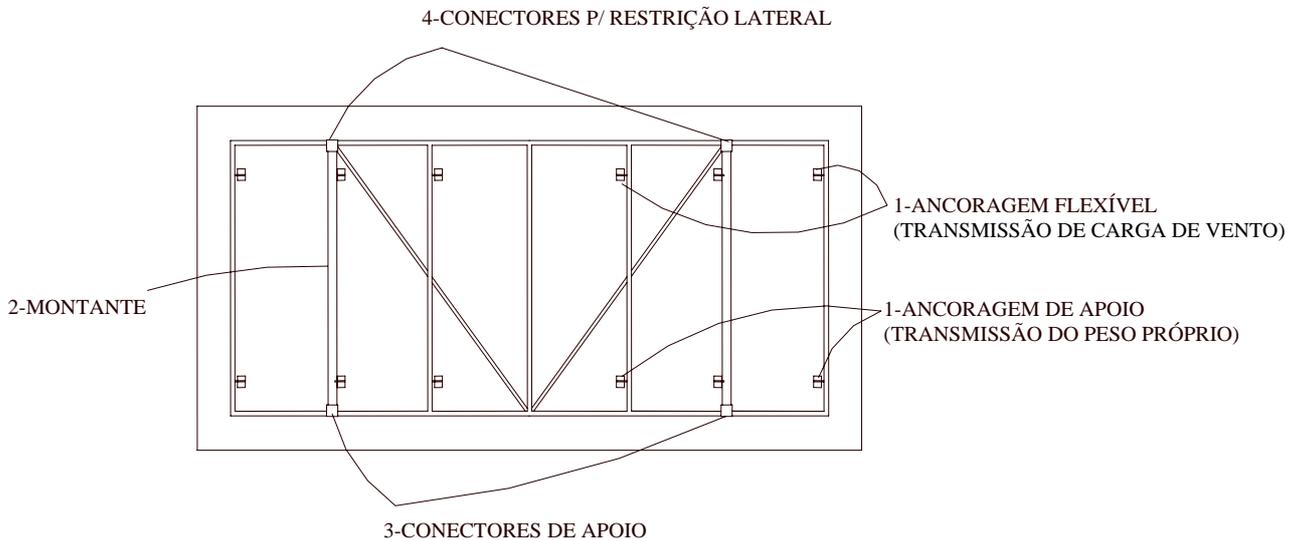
Elevação posterior do painel GRC, com o enrijecimento metálico.
